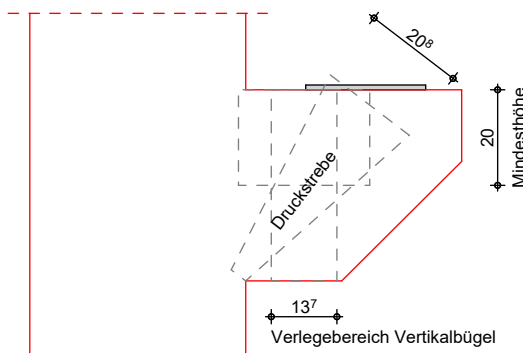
Mindestabmessungen der Konsole mit schräger Unterkante
